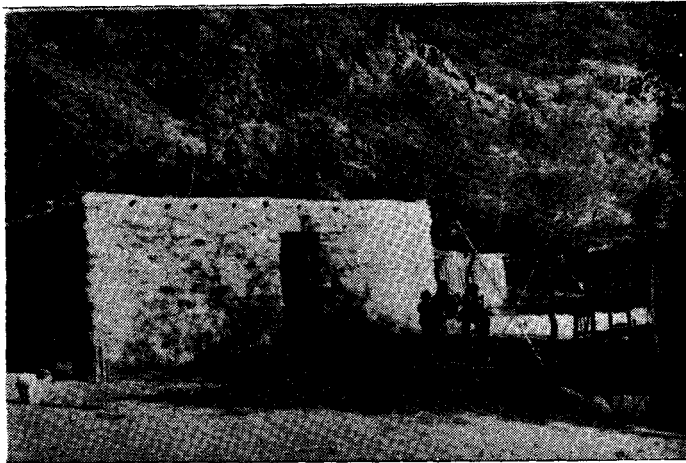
Rancho construido con piedras (Astica - Valle Fértil)
